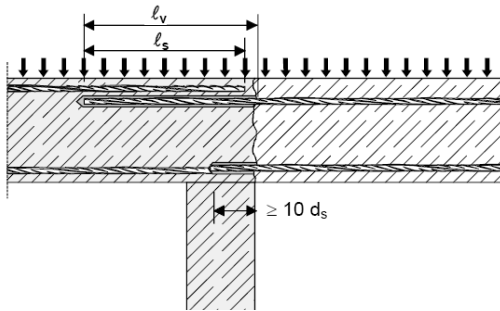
Recouvrement d'armatures pour la liaison de dalles et poutres
